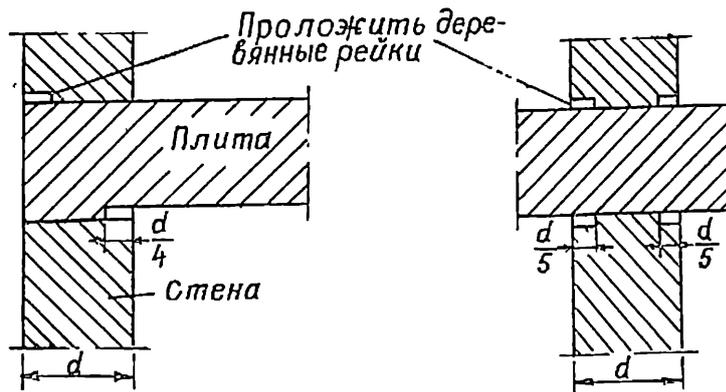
5. Центрирование нагрузок от стен на плиты
